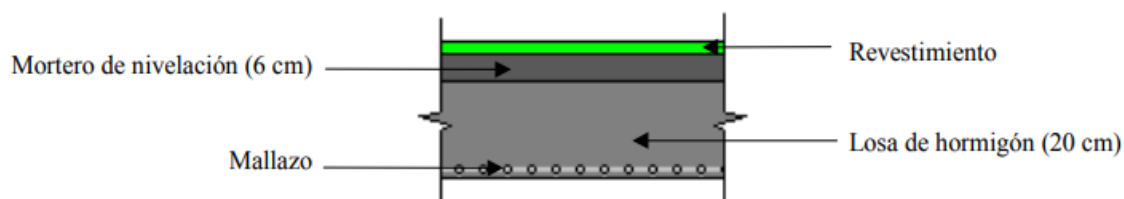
Entrepiso en bovedillas de hormigón 20 cm
